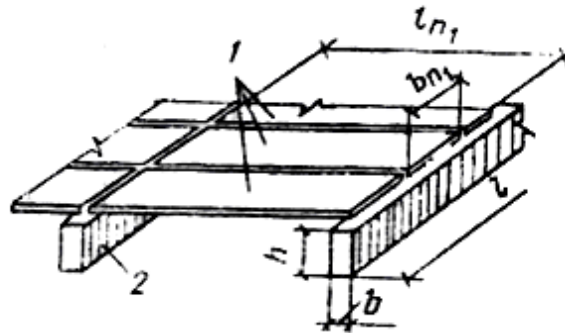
Схема збірного перекриття: 1 – плити; 2 – балки.
